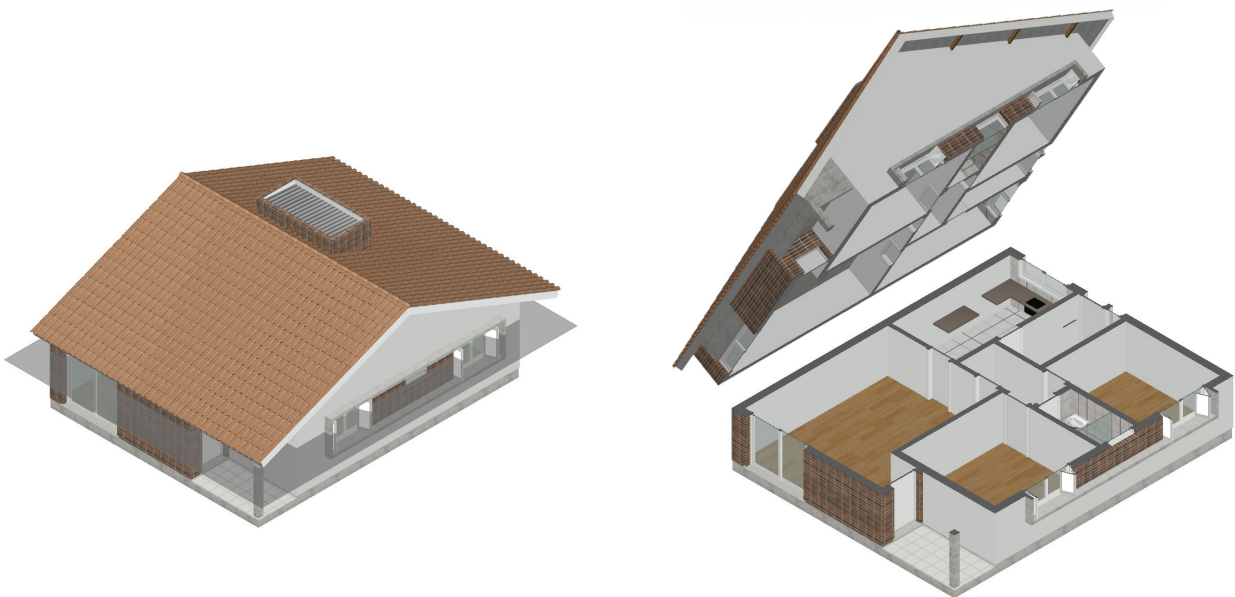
esquema do corte horizontal que gera a planta baixa. Fonte: Autor
